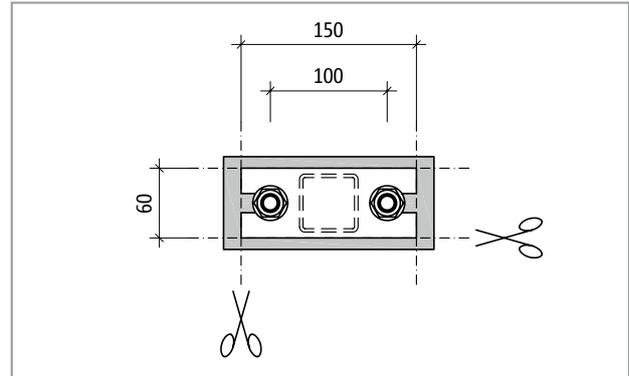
Schöck Isokorb® T tipo S-V: Dimensiones después de recortar el elemento aislante
